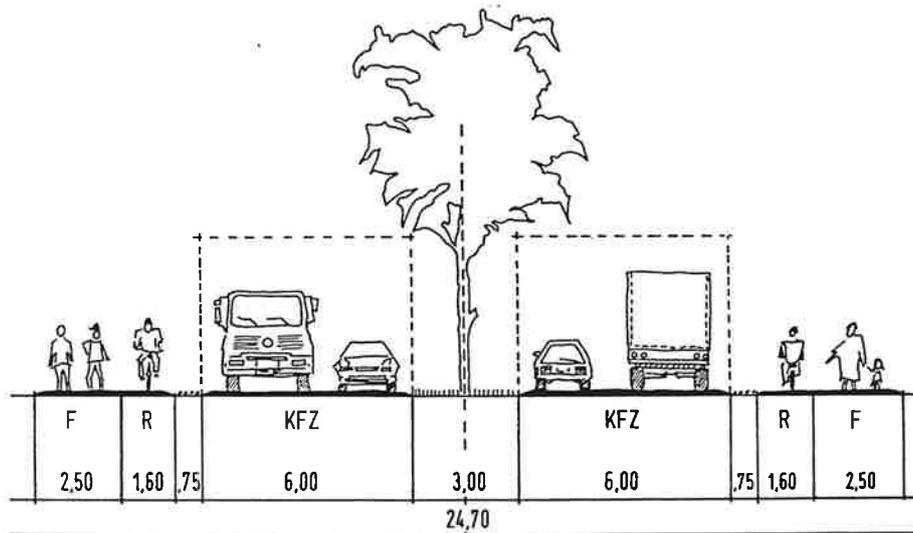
HAUPTSAMMELSTRASSE, ERNST-SCHNELLER-STRASSE, A₃-A₃
